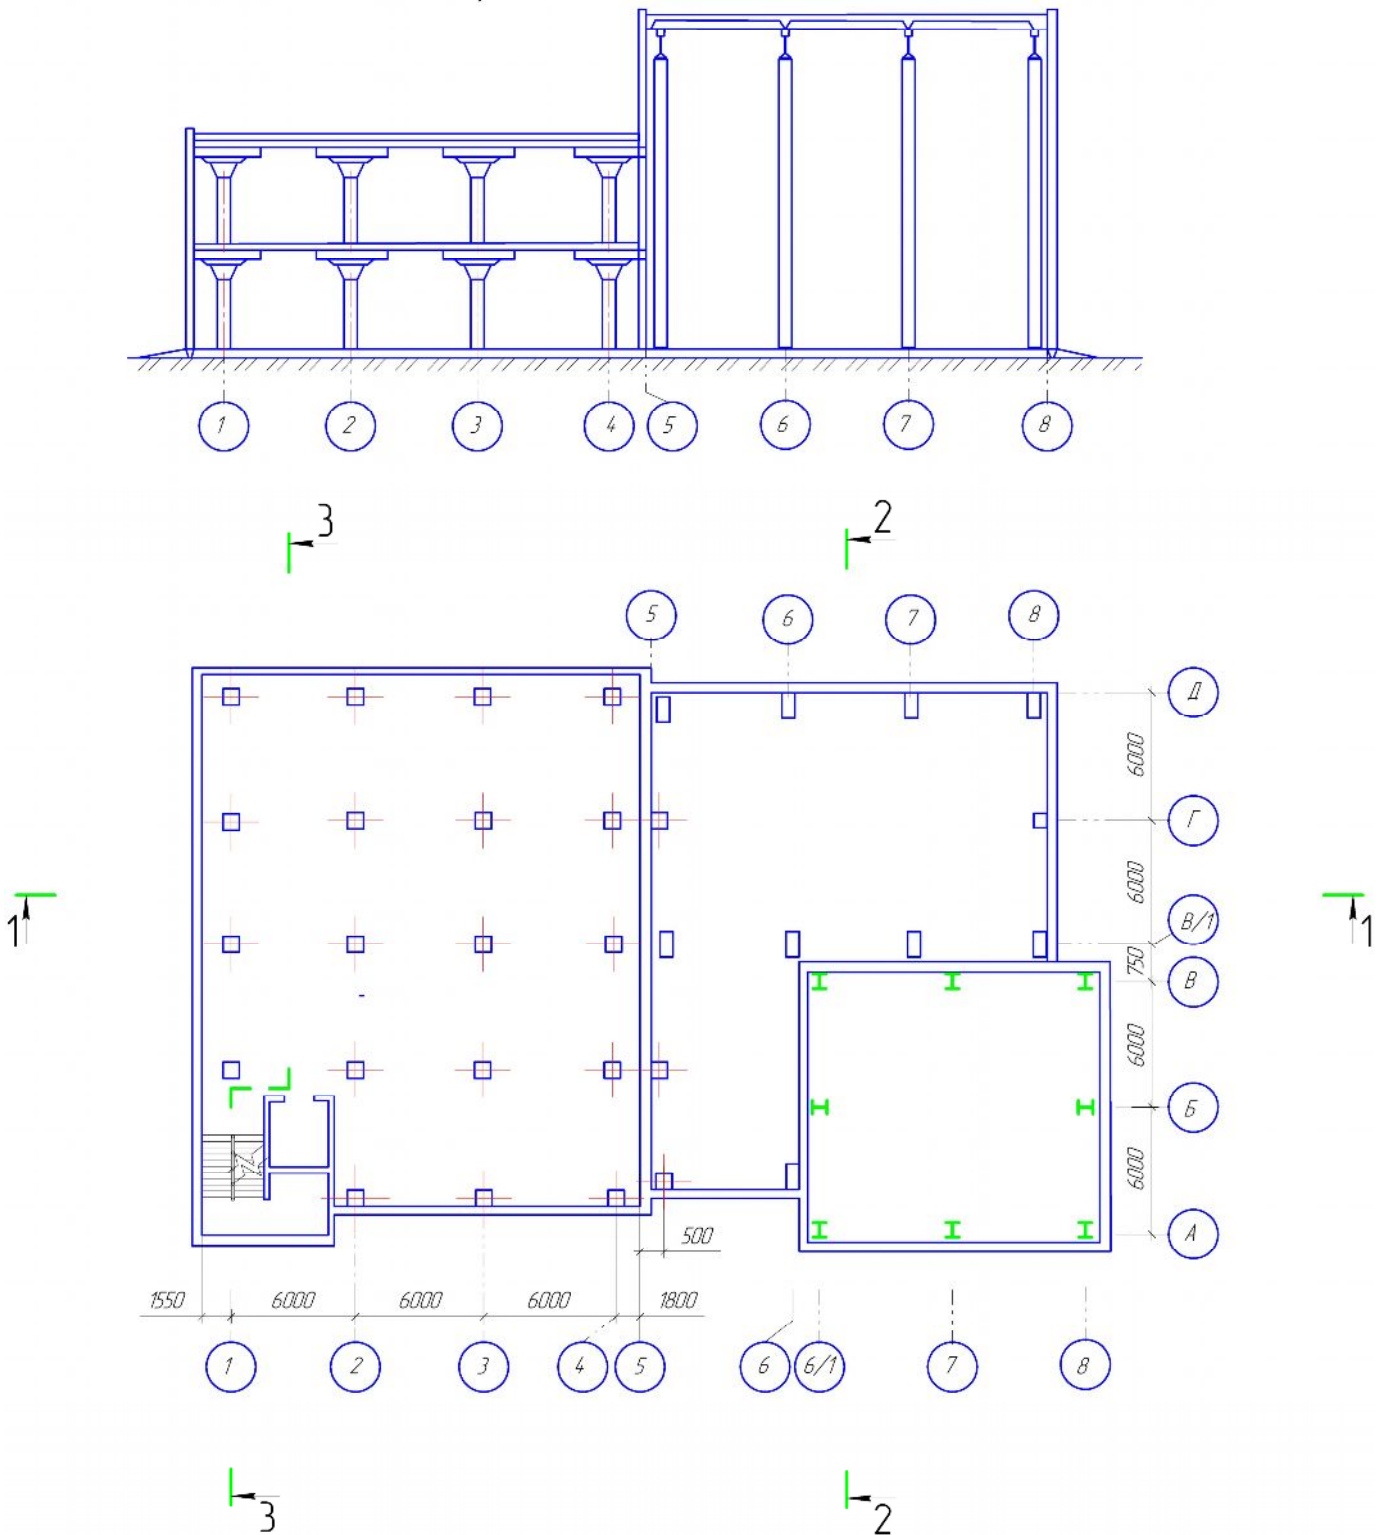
Схема плану та розрізу промислової будівлі до завдання контрольної роботи
